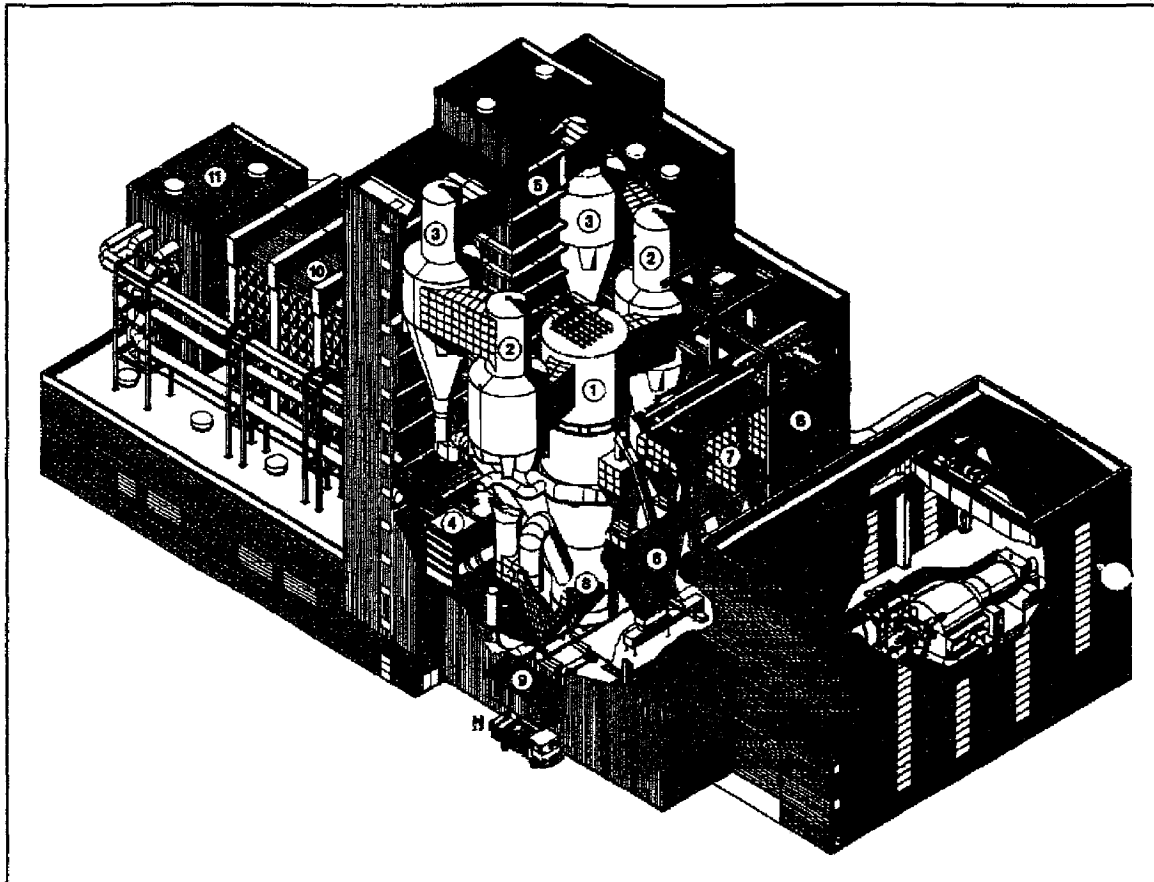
Heizkraftwerk der Stadtwerke Duisburg: Es ist das größte zur Zeit in Betrieb befindliche Kraftwerk mit zirkulierender Wirbelschichtfeuerung. 1 Kesselhaus mit Wirbelbrennkammer; 2 Primärzyklon; 3 Sekundärzyklon; 4 Fließbettkühler; 5 Nachschaltheizflächen; 6 Kohlebunker; 7 Kalkbunker; 8 Aschebunker; 9 Ascheverladestation; 10 Filtergebäude mit E-Filter; 11 Luftvorwärmer;
